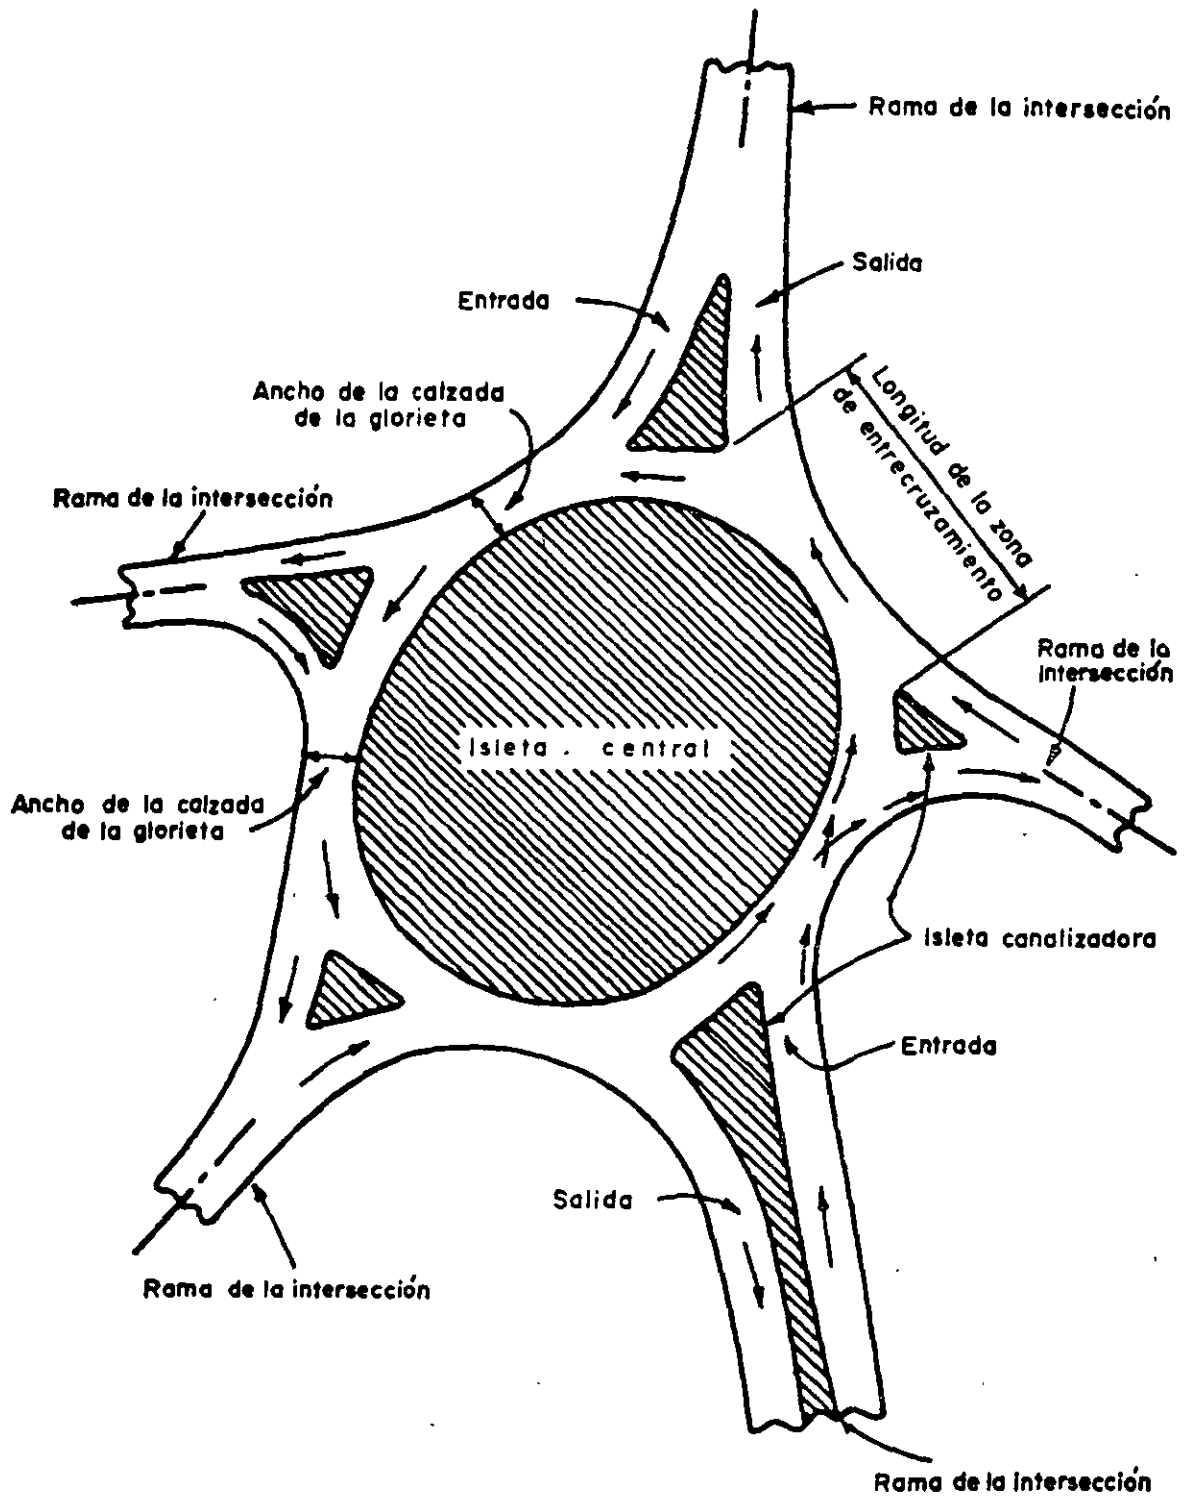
TERMINOS EMPLEADOS EN EL PROYECTO DE GLORIETAS
